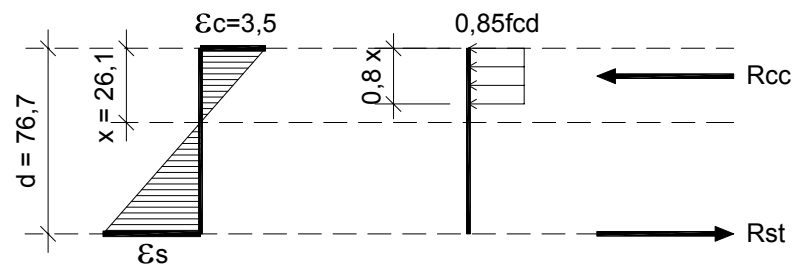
ELU – Distribuição de tensões e deformações da seção de concreto armado no domínio 3 com apenas armadura de tração
